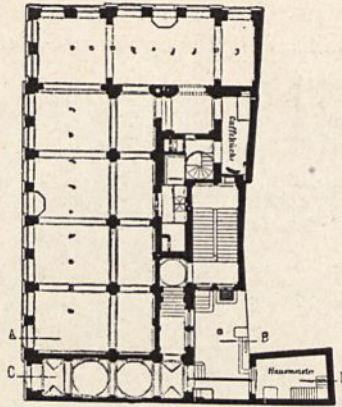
Haus zum Fensterguckerl in Wien. Grundriß.
